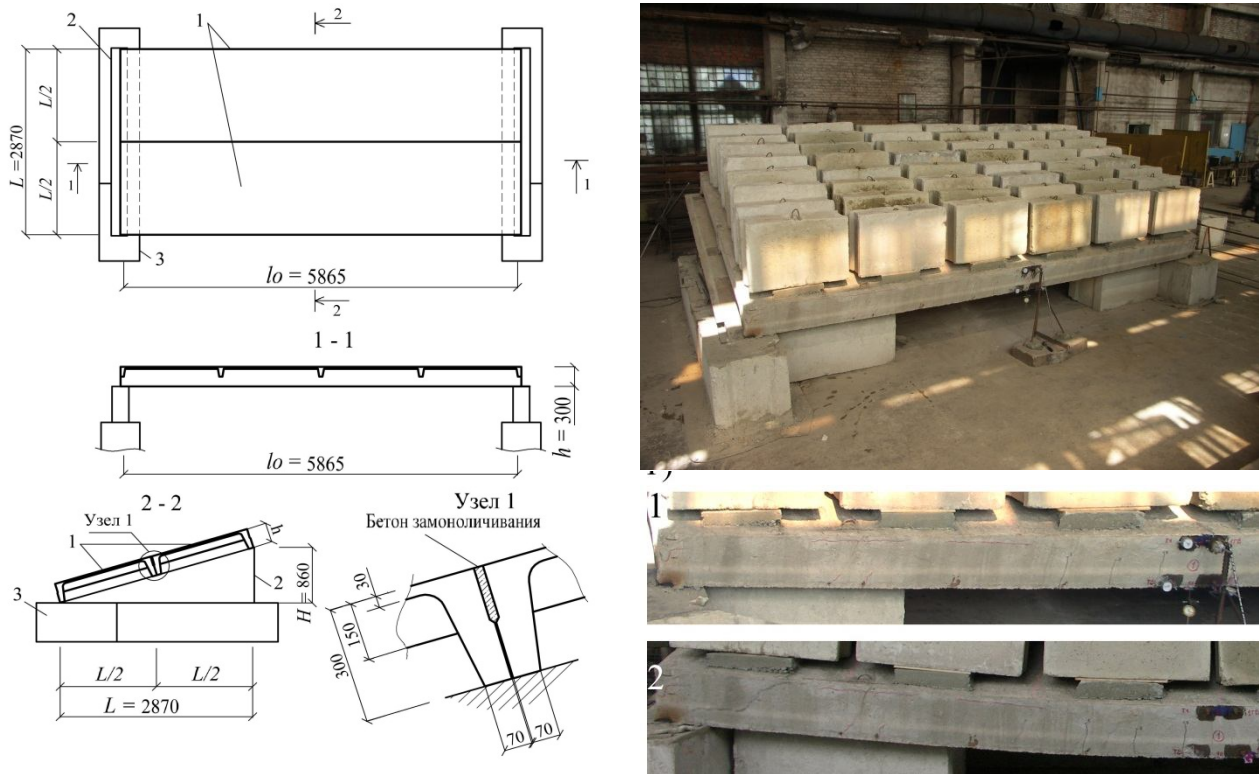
Схема конструкции опытного фрагмента складчатого покрытия (а); общий вид испытания фрагмента складчатого покрытия (б). 1 – железобетонные ребристые плиты; 2 – сталебетонная опора; 3 – опорные блоки испытательного стенда; трещинообразование (в): 1 – контрольное нагружение (ширина раскрытия нормальных трещин 0,05 мм, начиная с 5-го этапа нагружения); 2 – завершающий этап нагружения (ширина раскрытия трещин 0,25 мм, наклонных – 0,2 мм)
